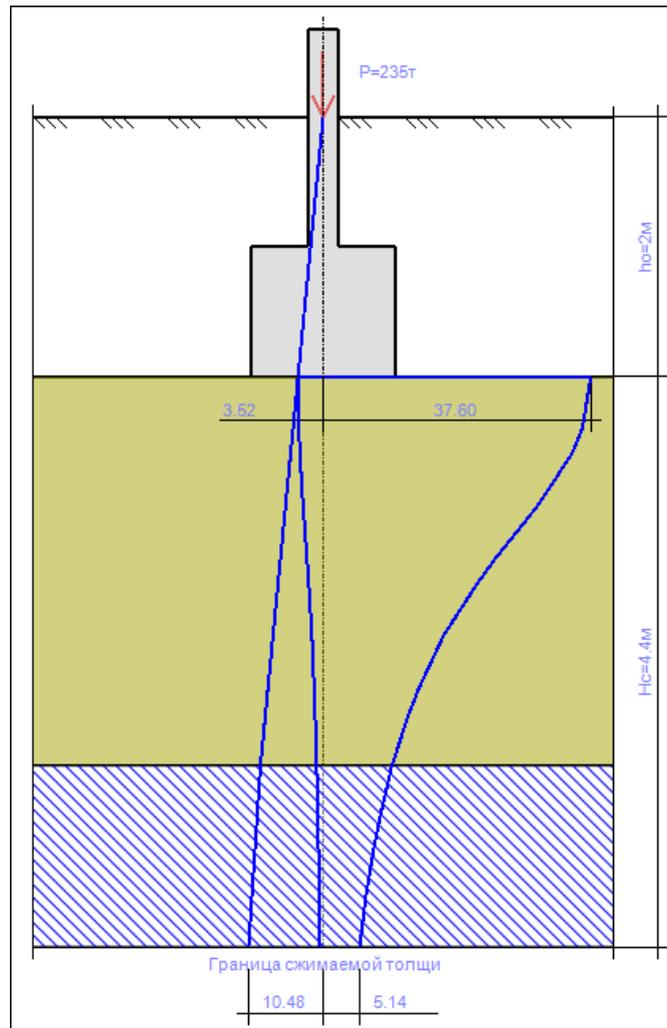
Расчетная схема к определению осадки фундамента Фк-1 и эпюры напряжений
